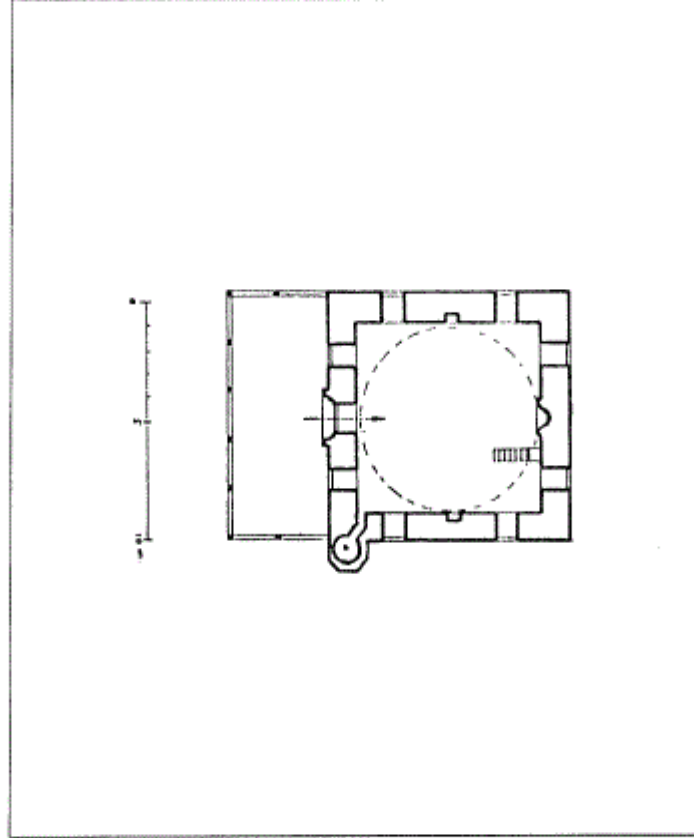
مكرر) مسقط أفقي لمسجد السوق في برلبيه (عن : كيل) .
